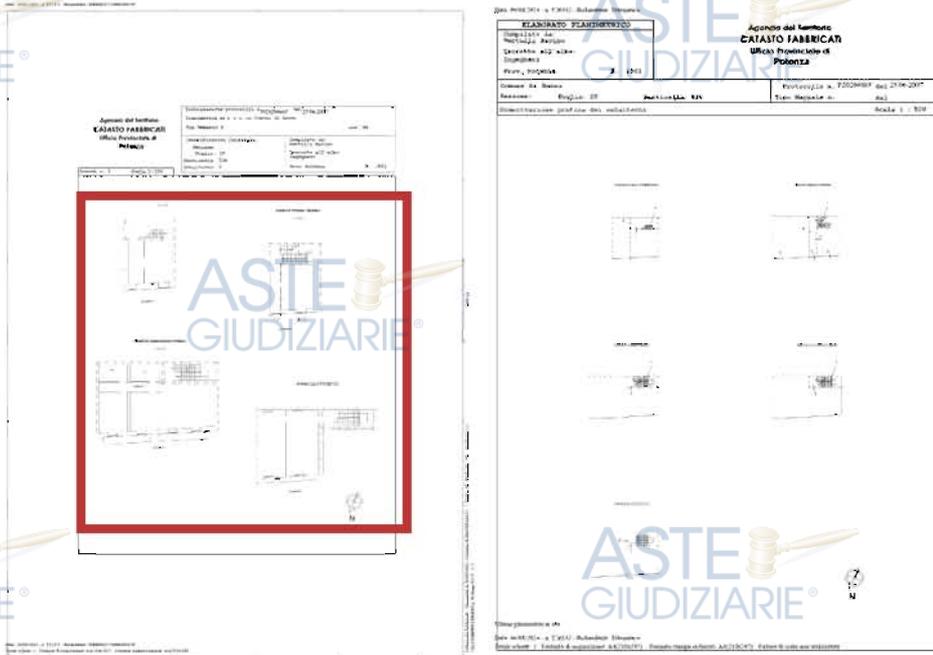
Raffronto stato reale con planimetria catastale Lotto L2 – Piano Terra (ALL. 05).
